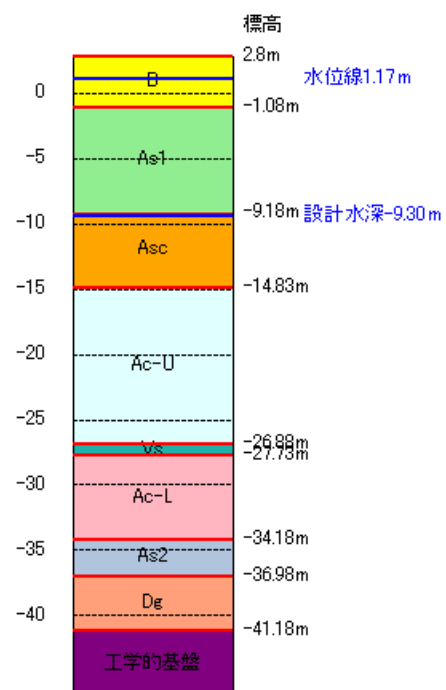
No.3 朝日地区-7.5m3号岸壁土質縦断面図
